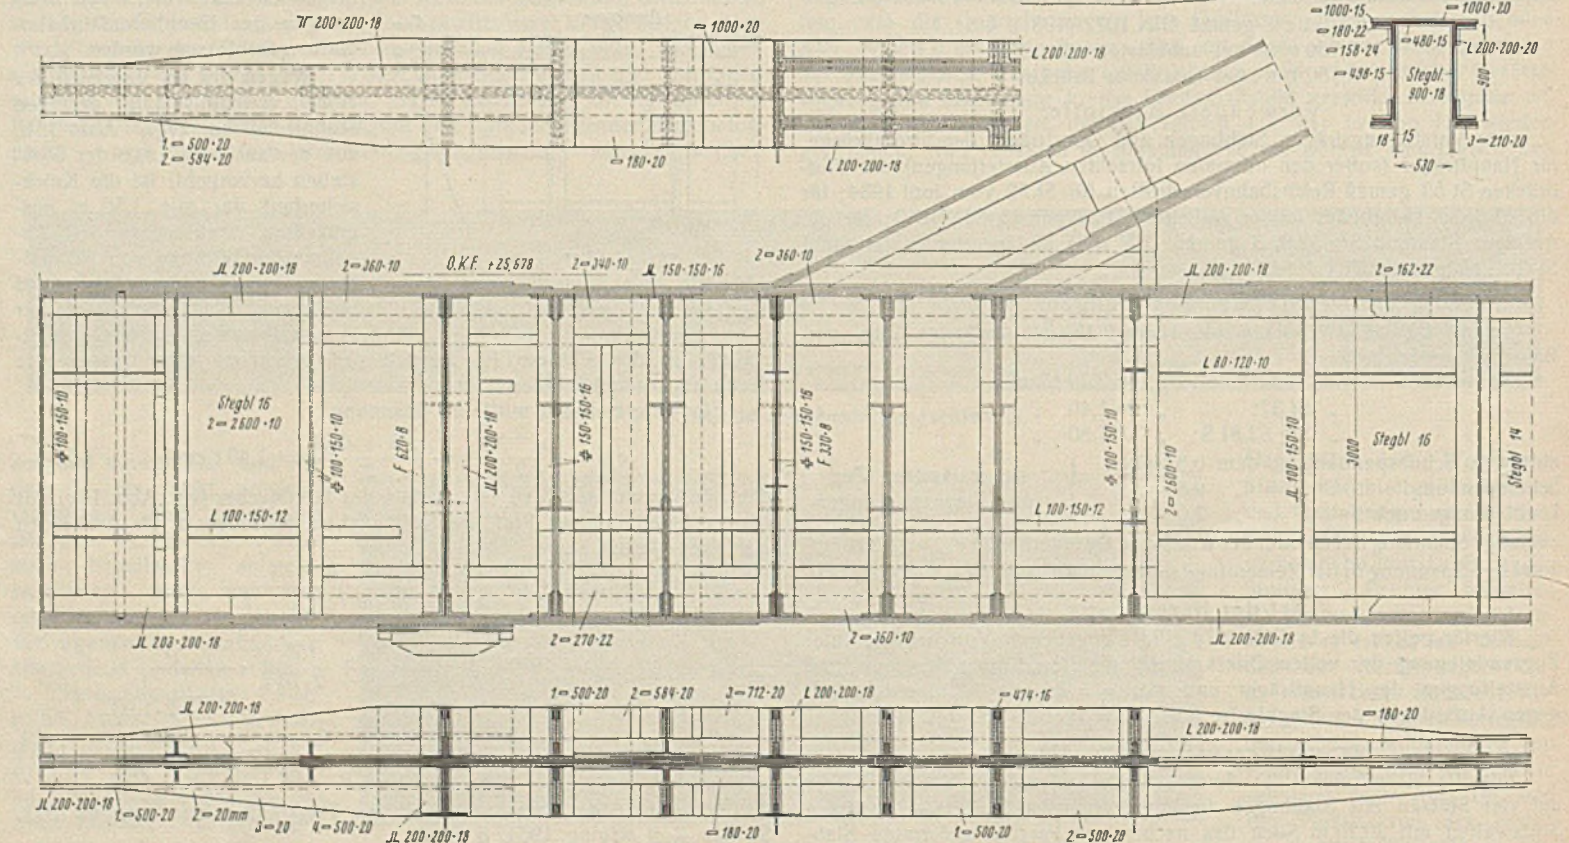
Konstruktive Ausbildung des Versteifungsträgers der Stromöffnung über Strompfeilerauflager.
